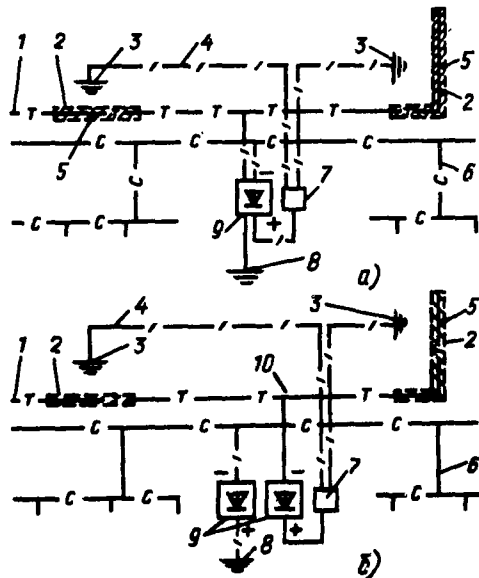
Электрохимическая защита трубопроводов тепловых сетей на участках заноса каналов грунтом:
